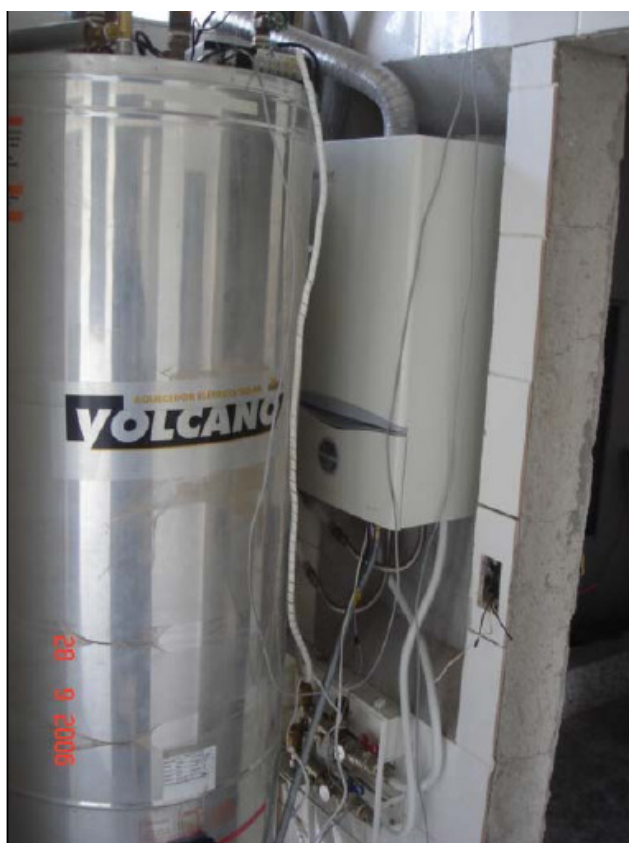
Aquecedor de passagem a gás instalado na área de serviço de um apartamento – HORTA (2009)
